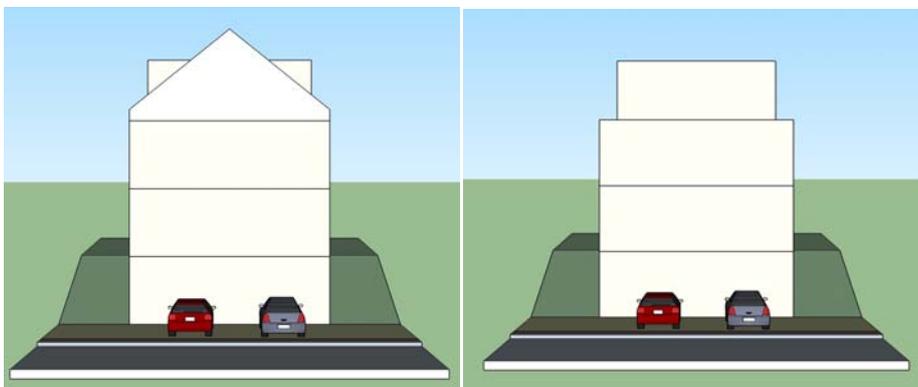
„Gebäudeprofile bei Sattel- und Flachdach“
